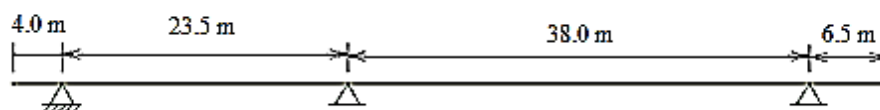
Modelo de Pré-dimensionamento para as Vigas Horizontais
